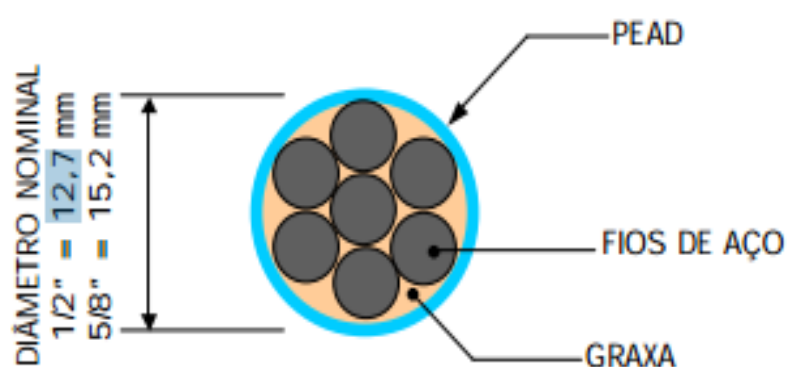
Seção de corte da monocordoalha engraxada de sete fios
